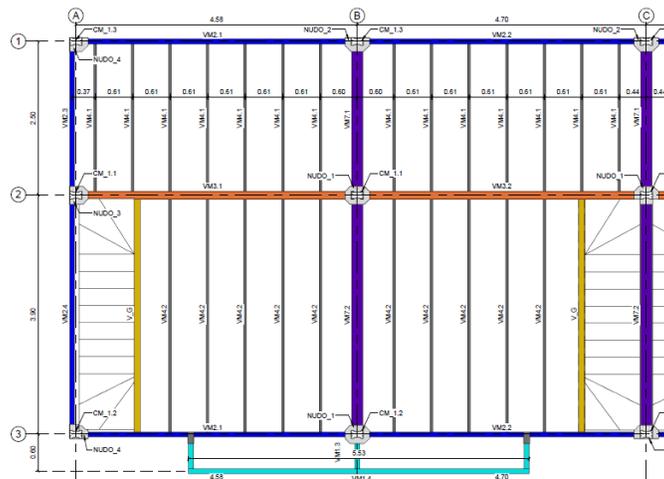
Planta estructural, segunda planta. Urbanización "Los Capulies".
